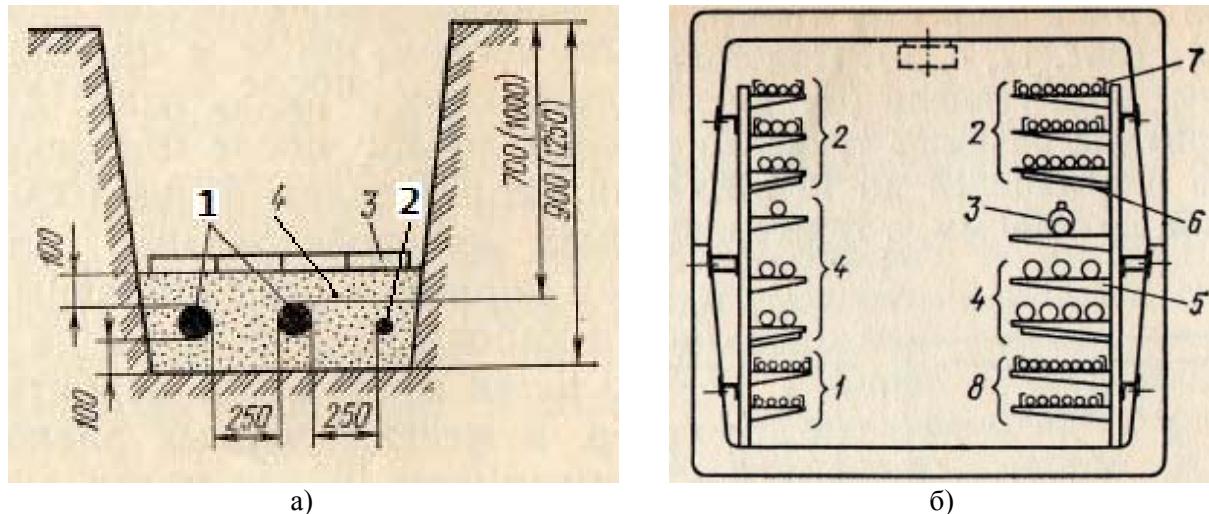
Кабельні споруди (а – земляна траншея; б – тунель)
